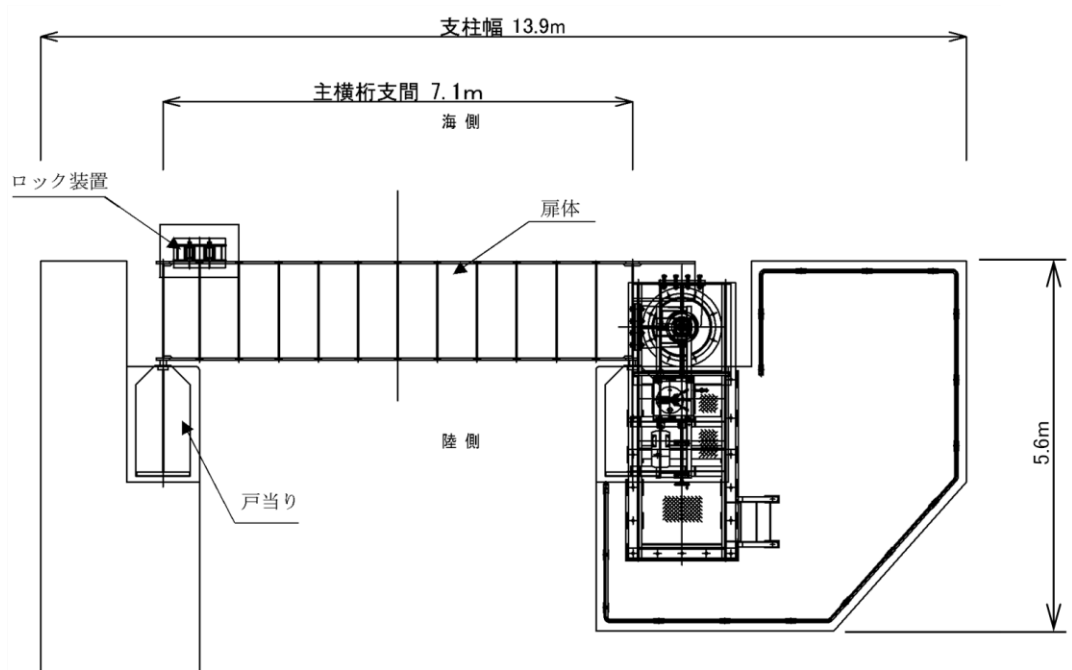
(2) 漂流物対策工の構造図（鋼製扉体，平面図）
